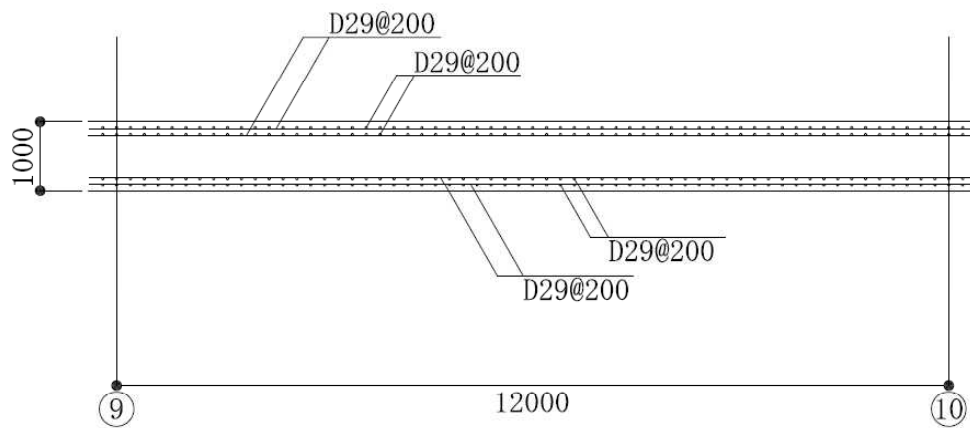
基礎スラブの配筋図 (F 通り、単位 : mm)
